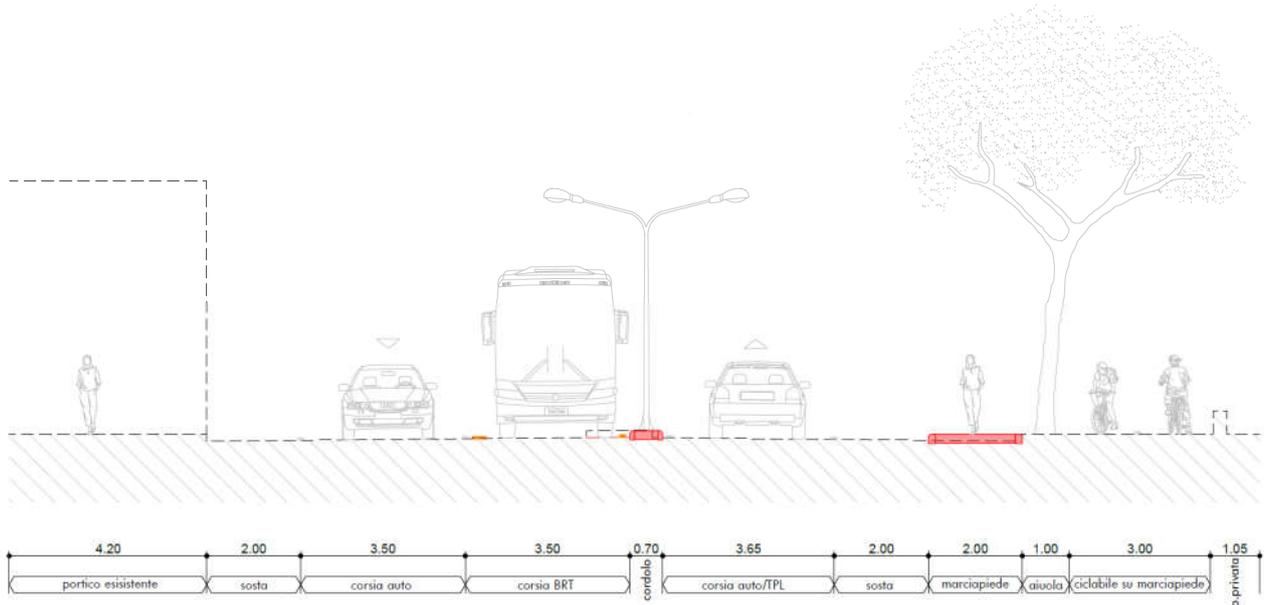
Fermata Minerbio Canaletto. Sezione Tipologica 1.
